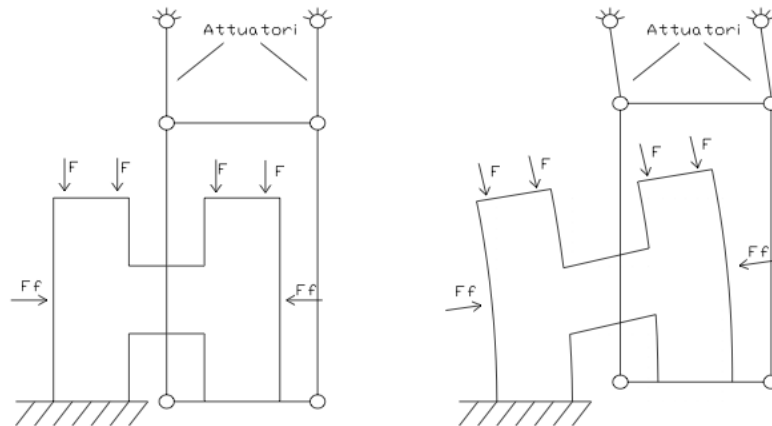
Schema der Lastaufbringung bei den am EUCENTRE, Pavia durchgeführten Versuchen an Mauerwerksriegeln.
